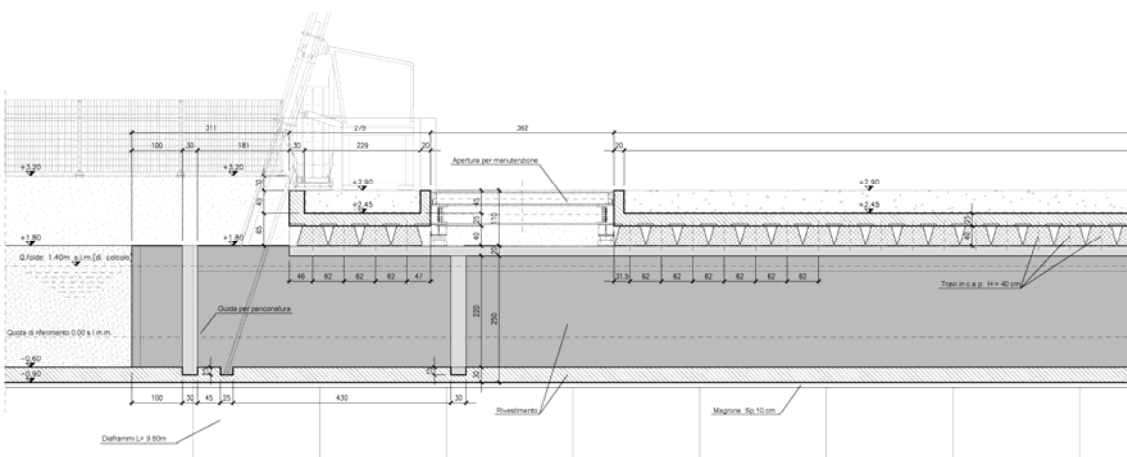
Impalcato 1 – Sezione longitudinale
